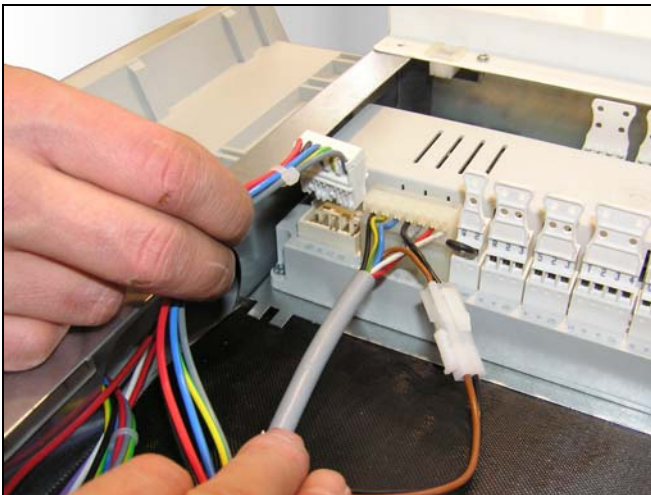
Schließen Sie das Kabel vom Kesselschaltfeld für die Spannungsversorgung des Kesselreglers an der Regelung (Steckkontakt L, PE, N, L1, S3) an.
